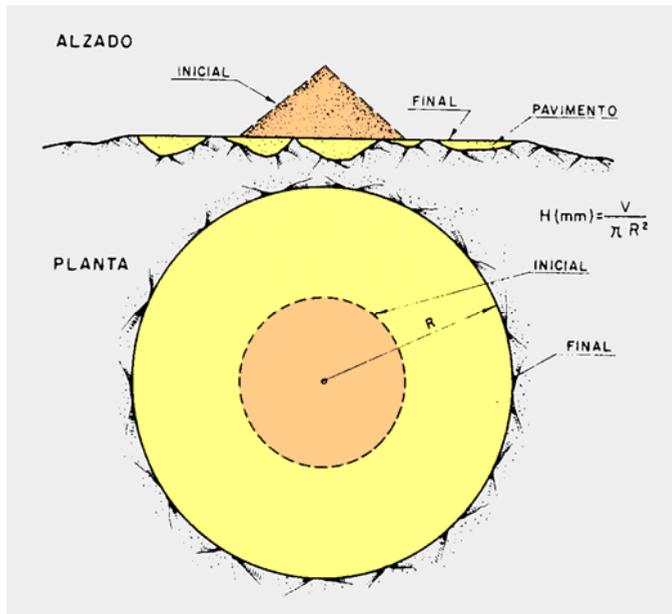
Ensayo del círculo de arena (NLT-335)
